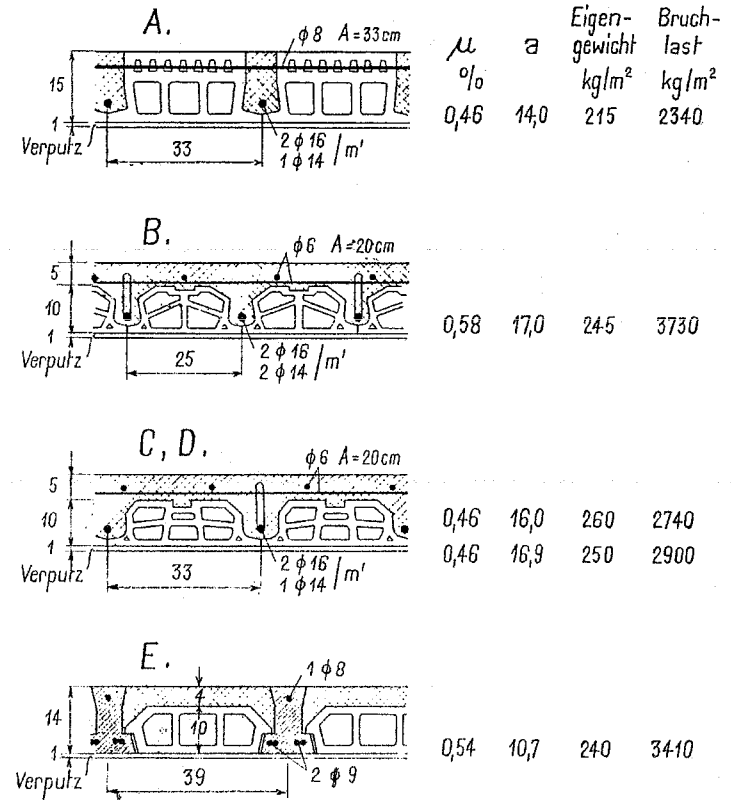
Querschnitte und Bewehrungen der fünf geprüften, allseitig freiaufliegenden Hohlkörper-Decken.
